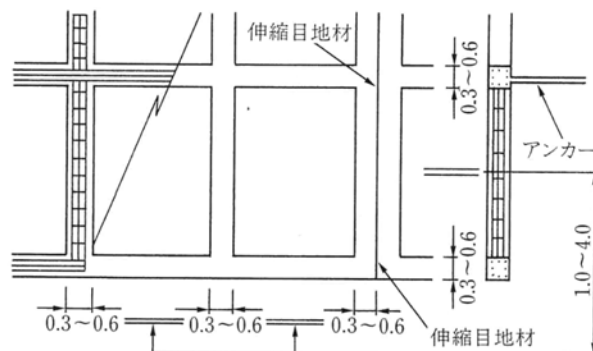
現場打コンクリート枠工の例 (単位:m) (新斜面崩壊 p182)
